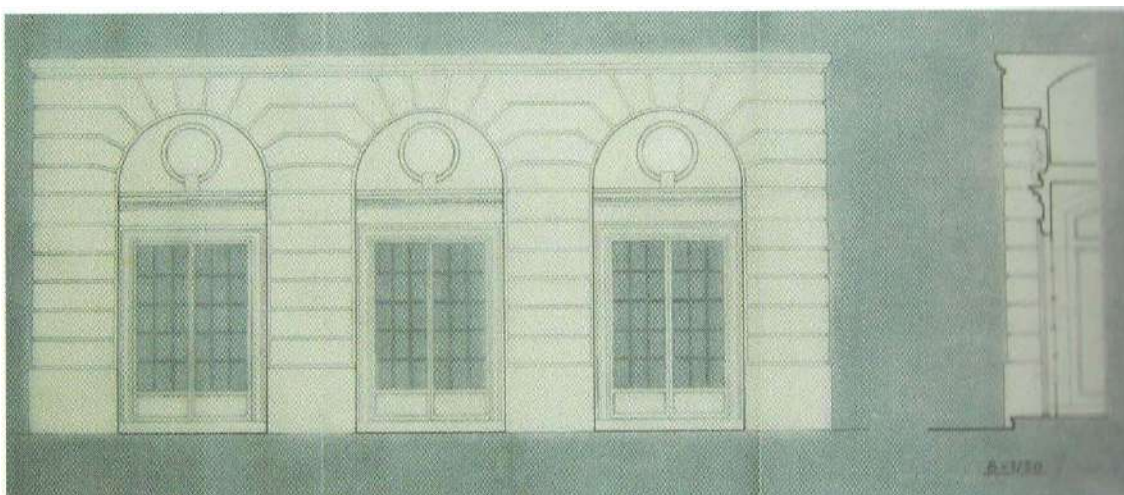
Detalle de carpinterías de Luis Albert Ballesteros
